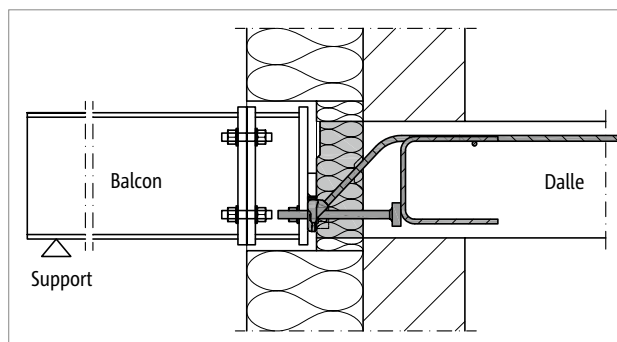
Schöck Isokorb® T type SQ : Raccordement de la poutre en acier à un adaptateur compensant l'épaisseur de l'isolation externe
